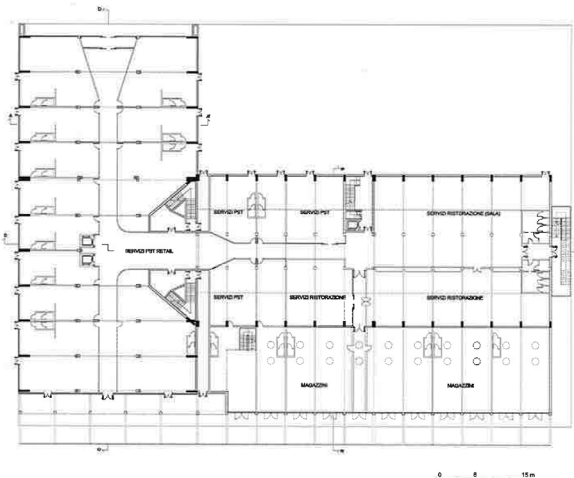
Erdgeschoss Grundriss, Armando Dal Fabbro.
